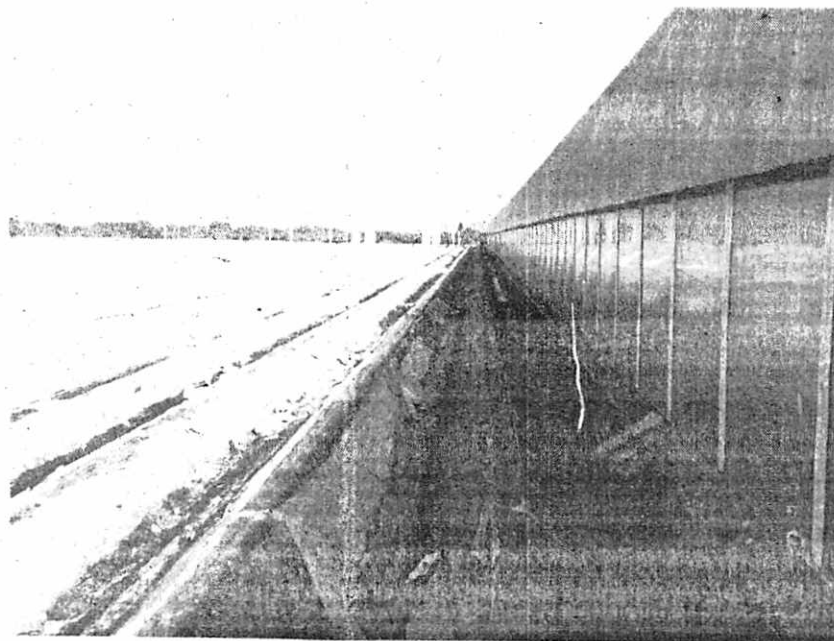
Vista geral do telhado apresentando desgaste em pontos localizados. Visualmente, não apresenta patologias de ordem estrutural que coloque em risco a segurança de seus usuários.
